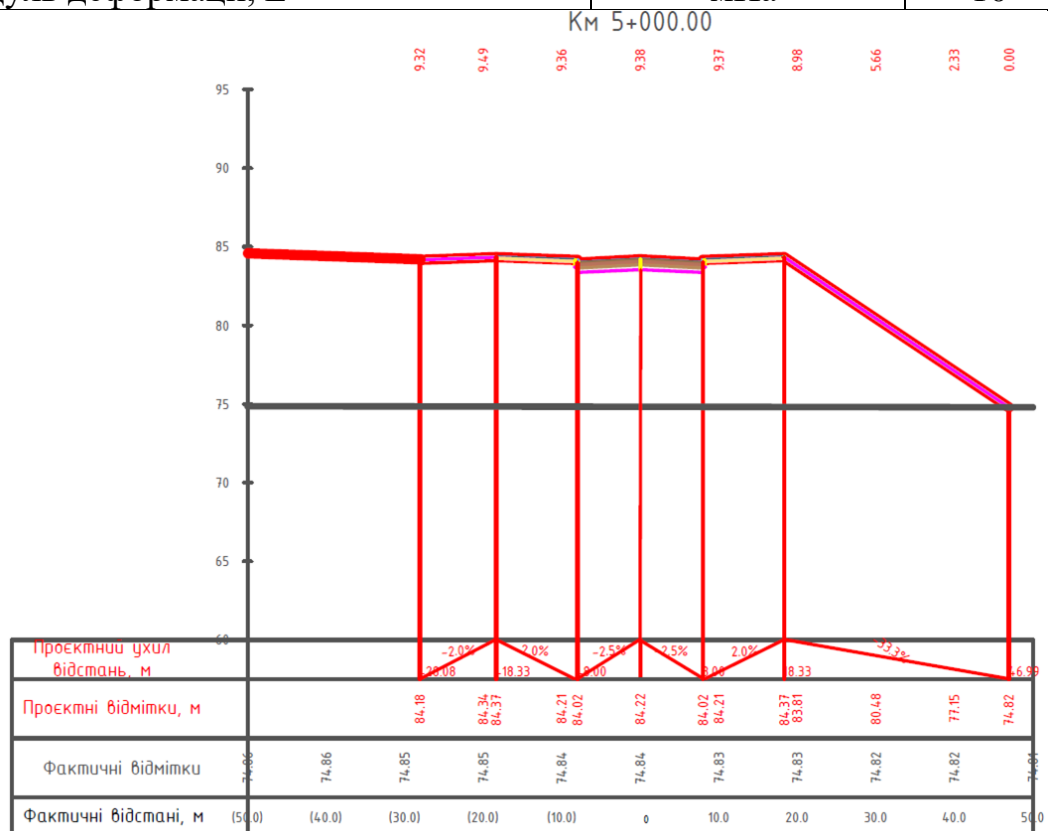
Поперечний переріз кам'яного насипу берегоукріплення, та
